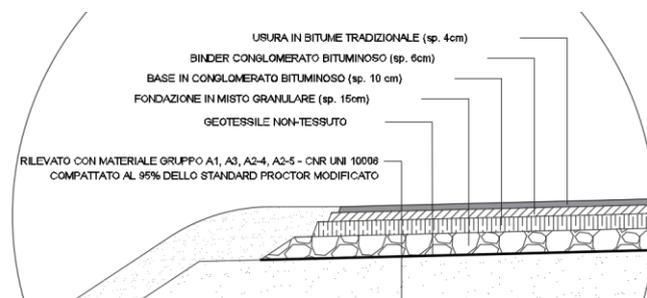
Pavimentazione in conglomerato bituminoso tradizionale
